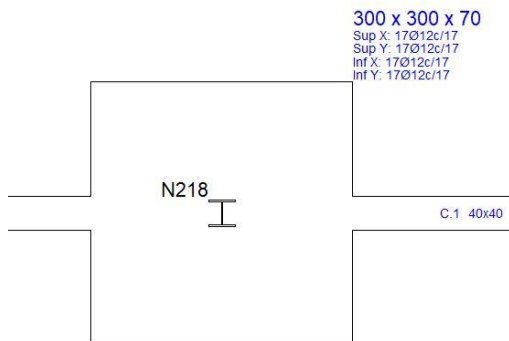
Zapata pórtico central tipología cercha.
